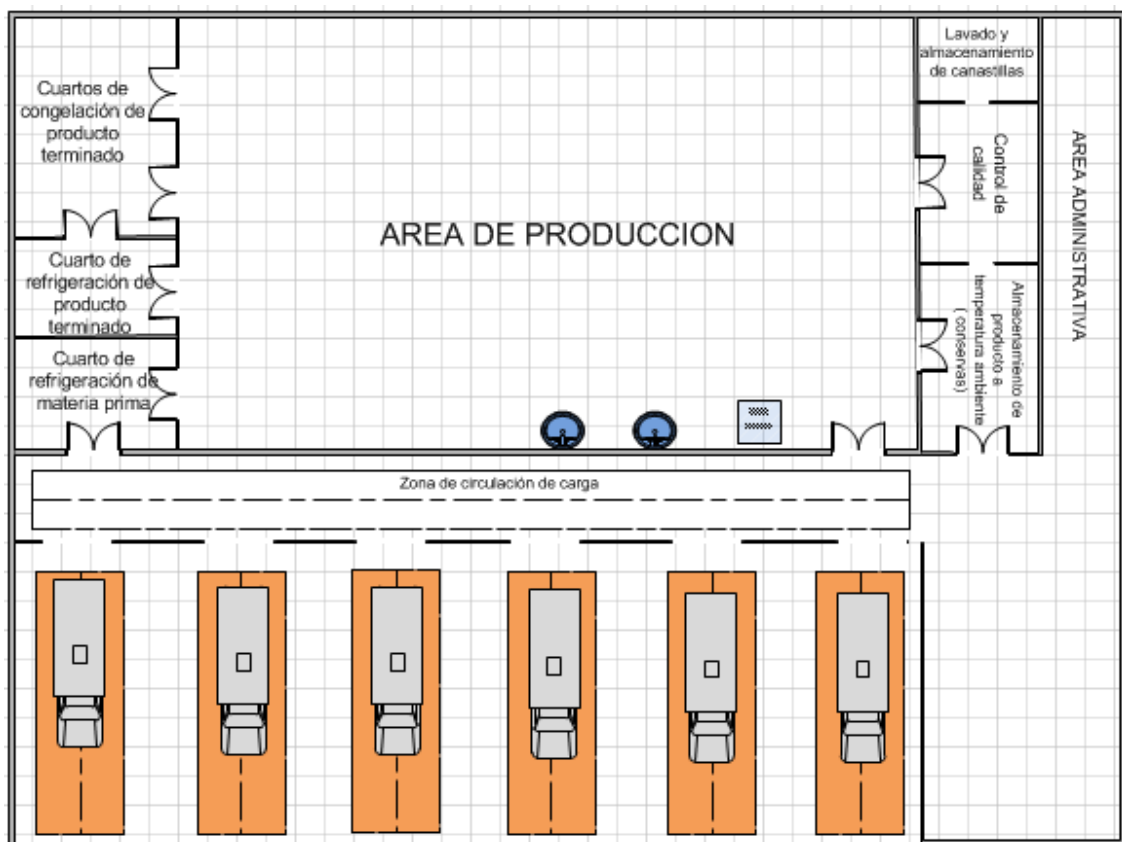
, Plano actual de la Plataforma Logística Los Luceros, planta primer piso. Fuente el Autor.
